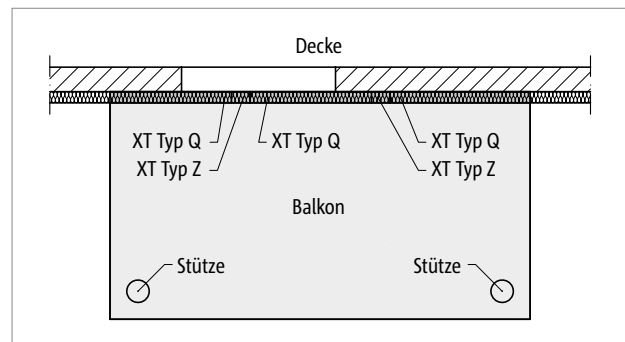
Schöck Isokorb® XT Typ Z, Q: Balkon mit Stützenlagerung
